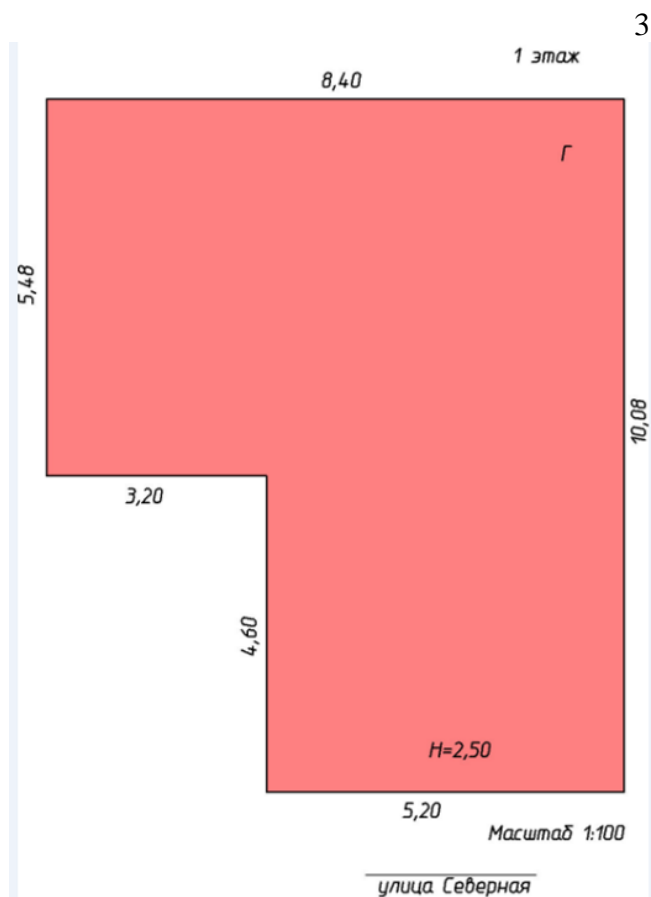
отсутствие на Плана этажа конструктивных элементов (стены и перегородки, в том числе внутренние, окна и двери, лестницы, балконы, внутренние выступы стен - п.59 Требований к ТП)
